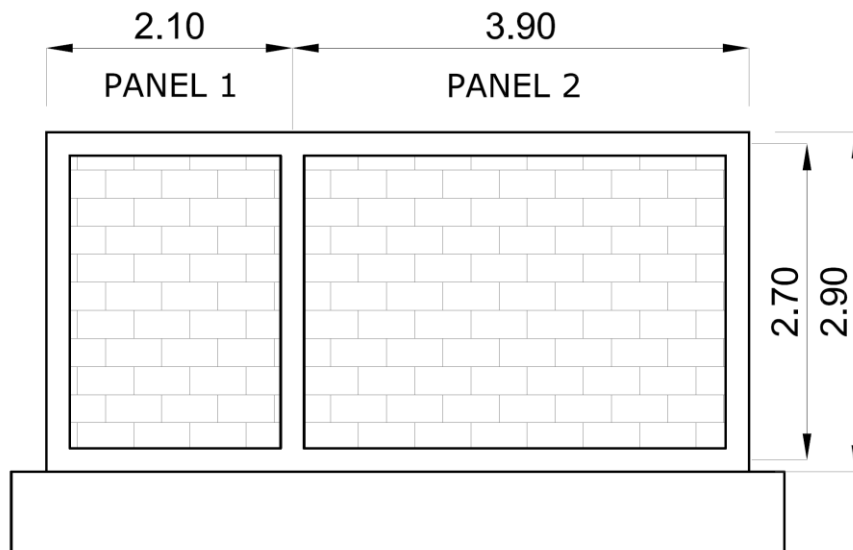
Panel 1 y Panel 2 en el Muro MIY
